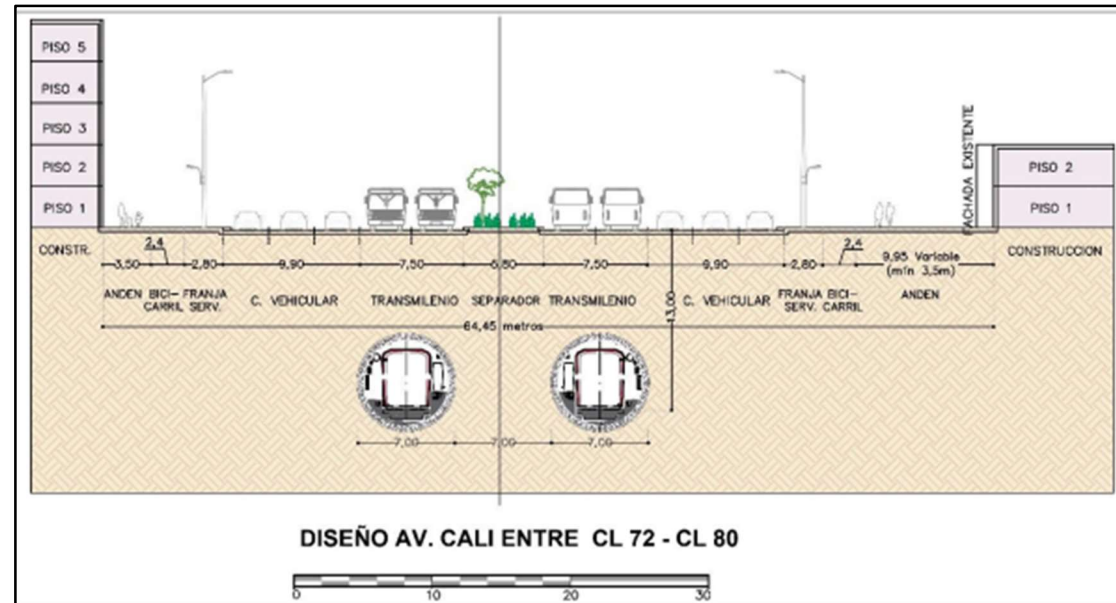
Perfil vial definido para Av. Ciudad de Cali (entre calle 72 y calle 80).
